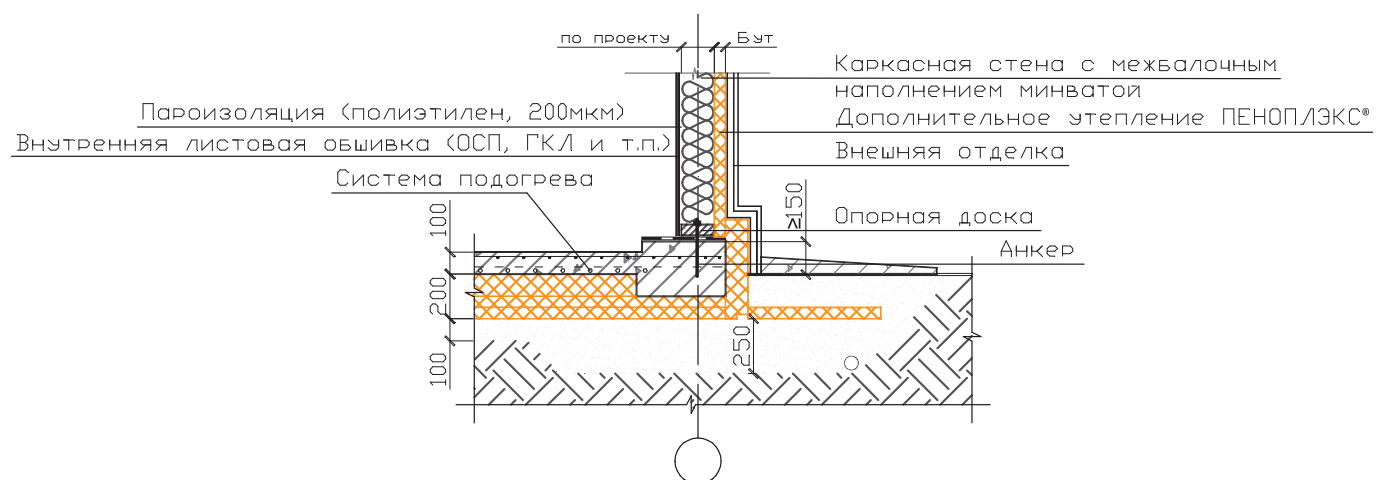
Схема сопряжения фундамента глубокого заложения и каркасной стены.
